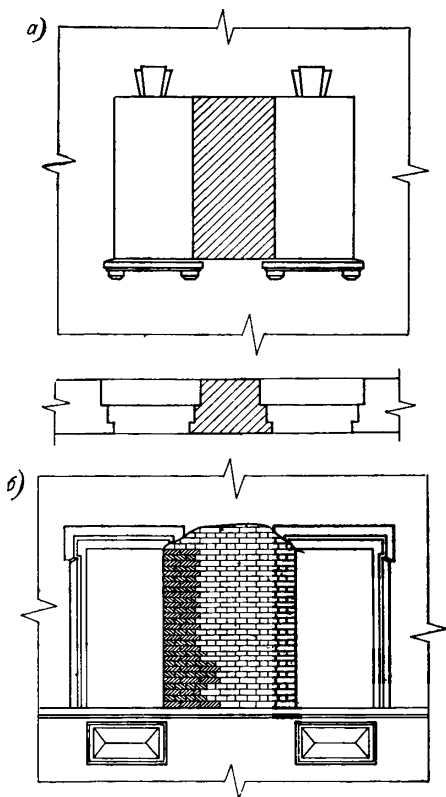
Усиление кирпичного простенка путем его перекладки
